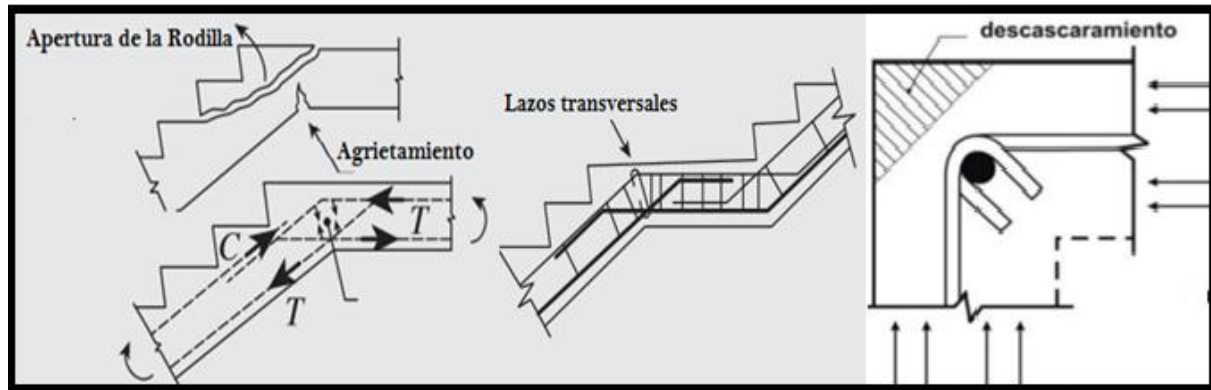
Acción de las fuerzas en escaleras y armado recomendado (ganchos).
